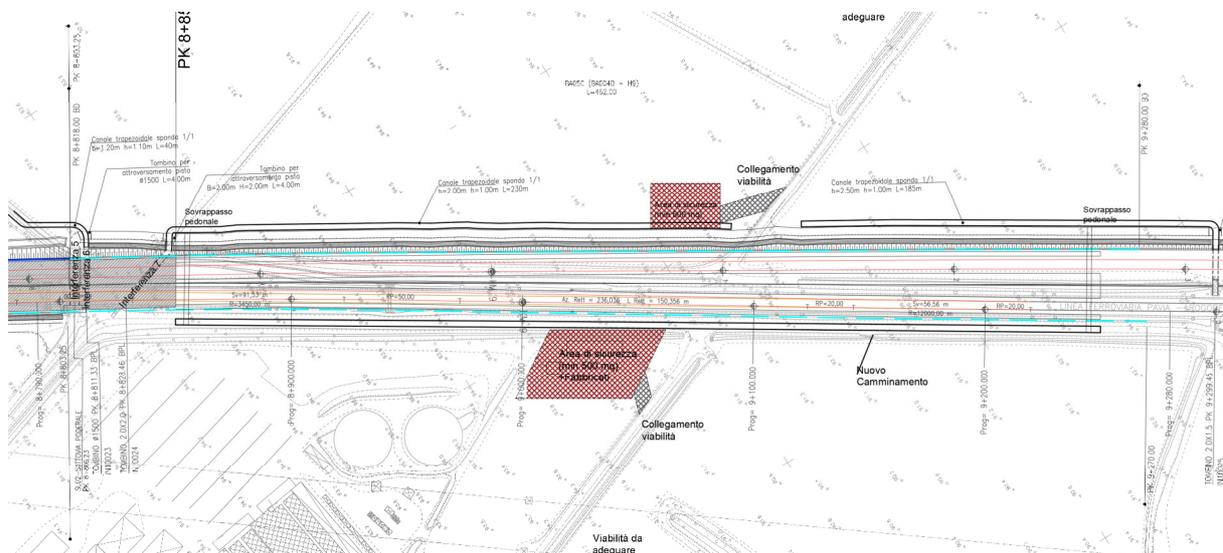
Stralcio planimetrico imbocco direzione Pavia con collocazione delle aree di sicurezza.
